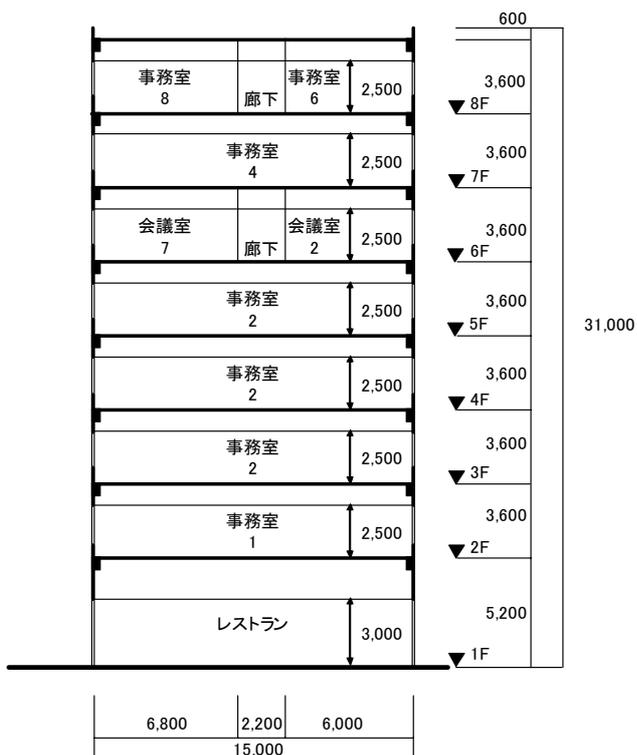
断面図 ((a)-(a)断面 (図 3.2-3 参照))
